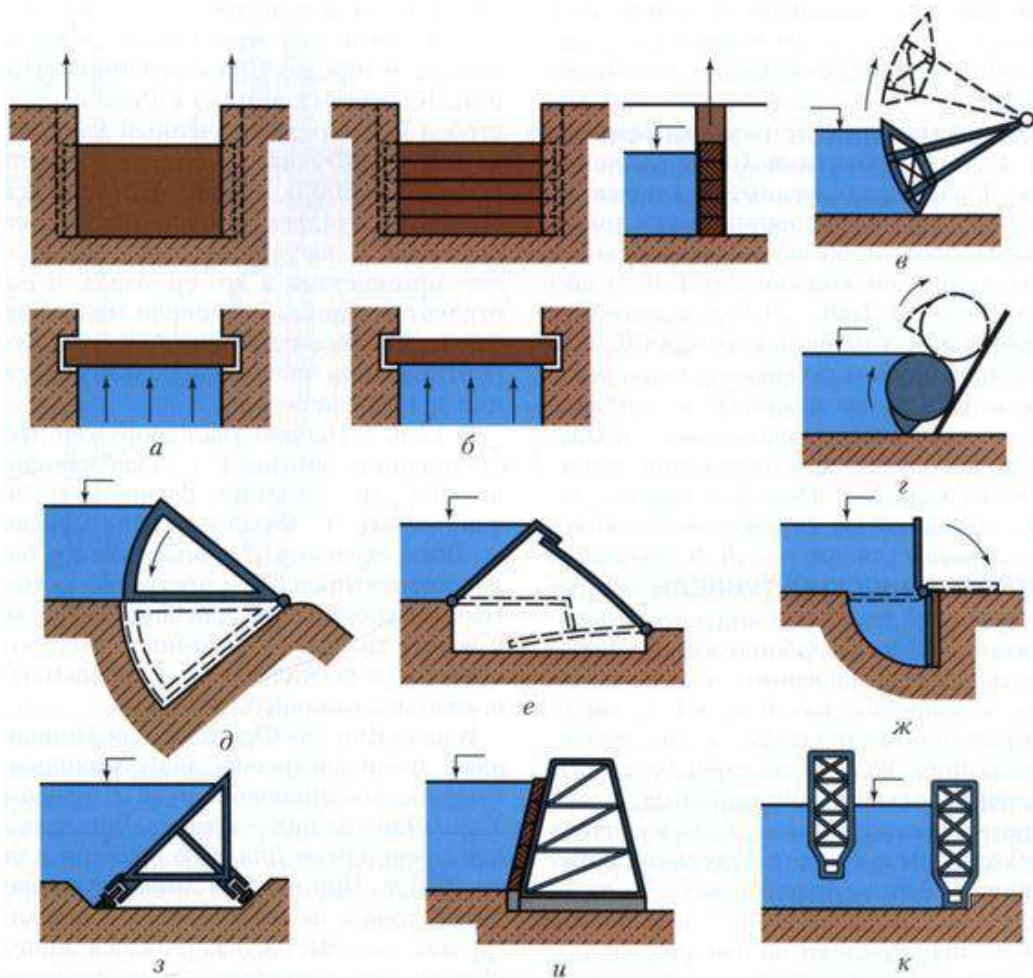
Основные типы поверхностных затворов: а – плоский; б – шандорный; в – сегментный; г - вальцовый; д – секторный; е – крышевидный; ж – клапанный; з – откатной; и – с поворотными фермами; к - плавучие
